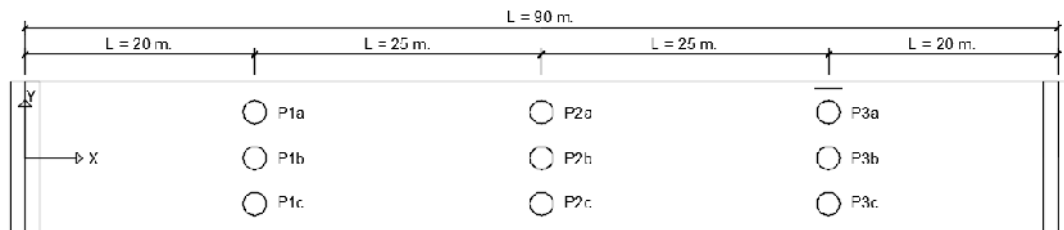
Vista en planta del modelo final para el Diseño sin aislamiento sísmico
